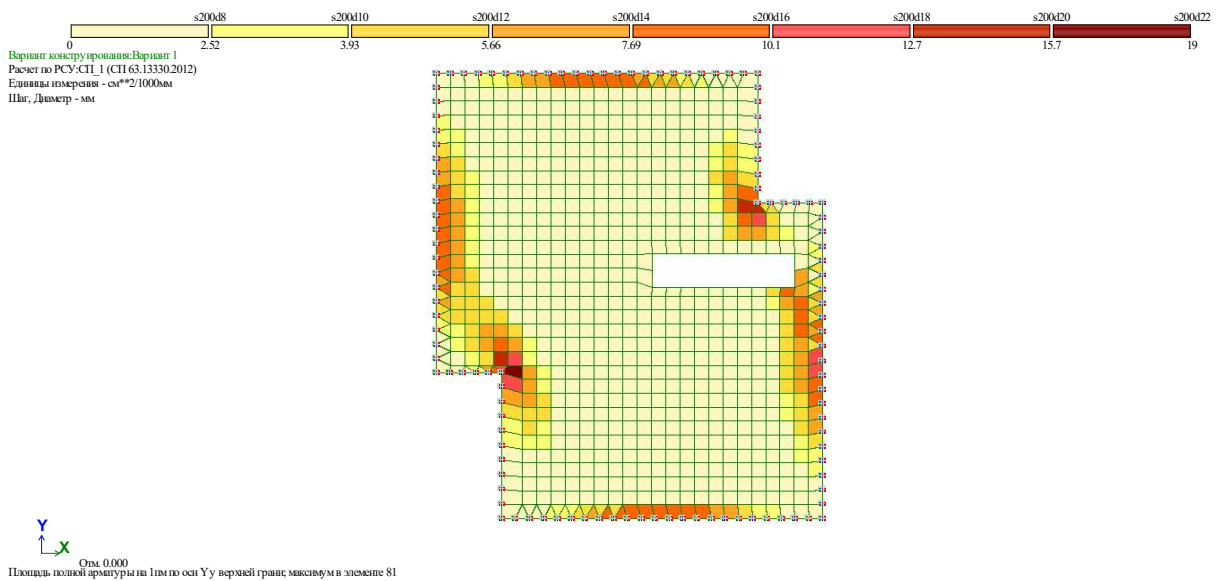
Площа арматури на 1п.м. по осі Y у верхній грані
